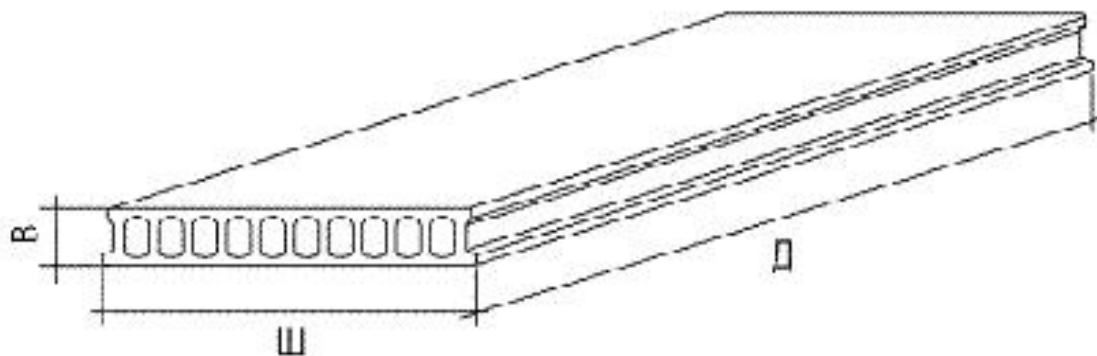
Многопустотная плита перекрытия ПБ высотой 300 мм.
